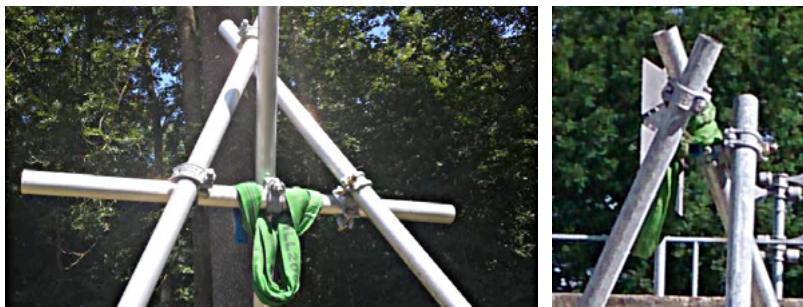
Improvisierte Dreibeinkonstruktionen mit Gerüstrohren
